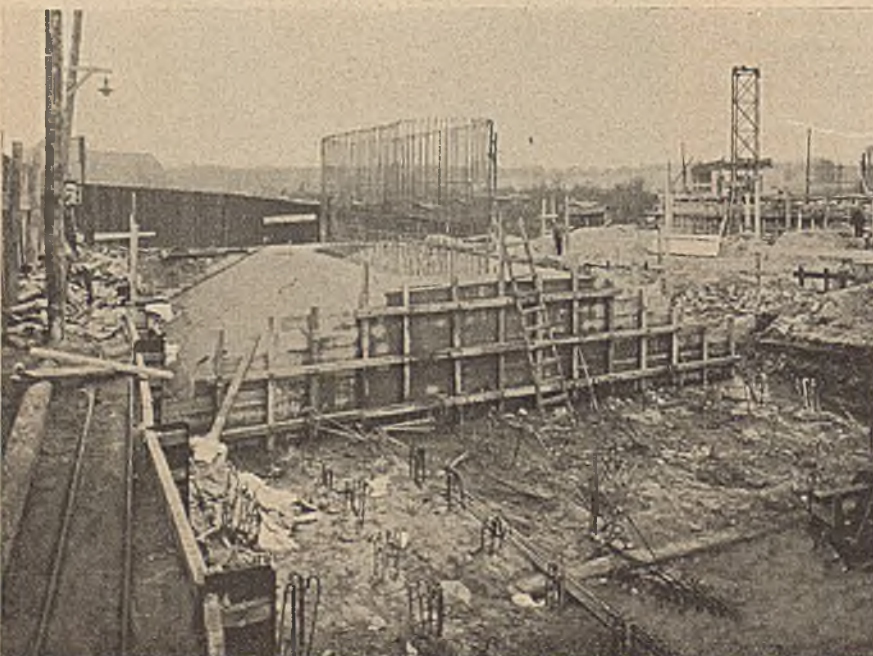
Nordpfeiler am Siemensdamm. Pfahlkopf Bewehrung, hintere Hälfte des Fundamentes bereits betonierte und mit der Bewehrung für den aufgehenden Beton des Pfeilers versehen.
